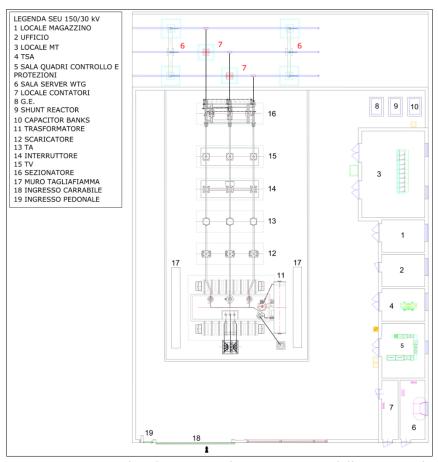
Dettaglio planimetria elettromeccanica della SEU 150/30 kV
